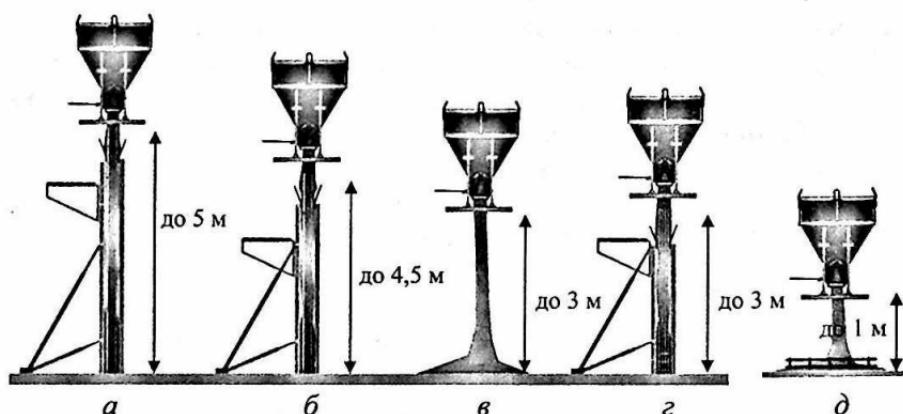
Ограничения по высоте сбрасывания бетонной смеси при бетонировании конструкций разного типа (бетонная смесь условно показана зеленым цветом):
